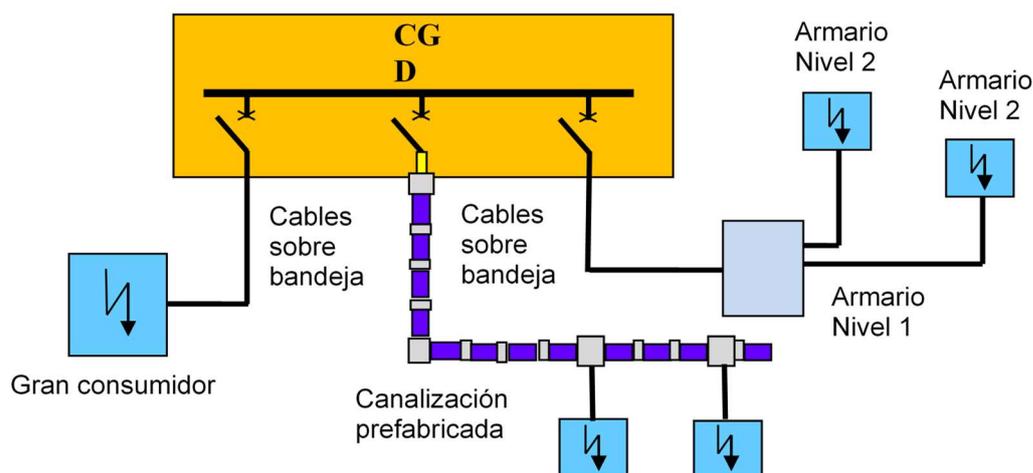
Esquema de principio de distribución eléctrica en baja tensión.
